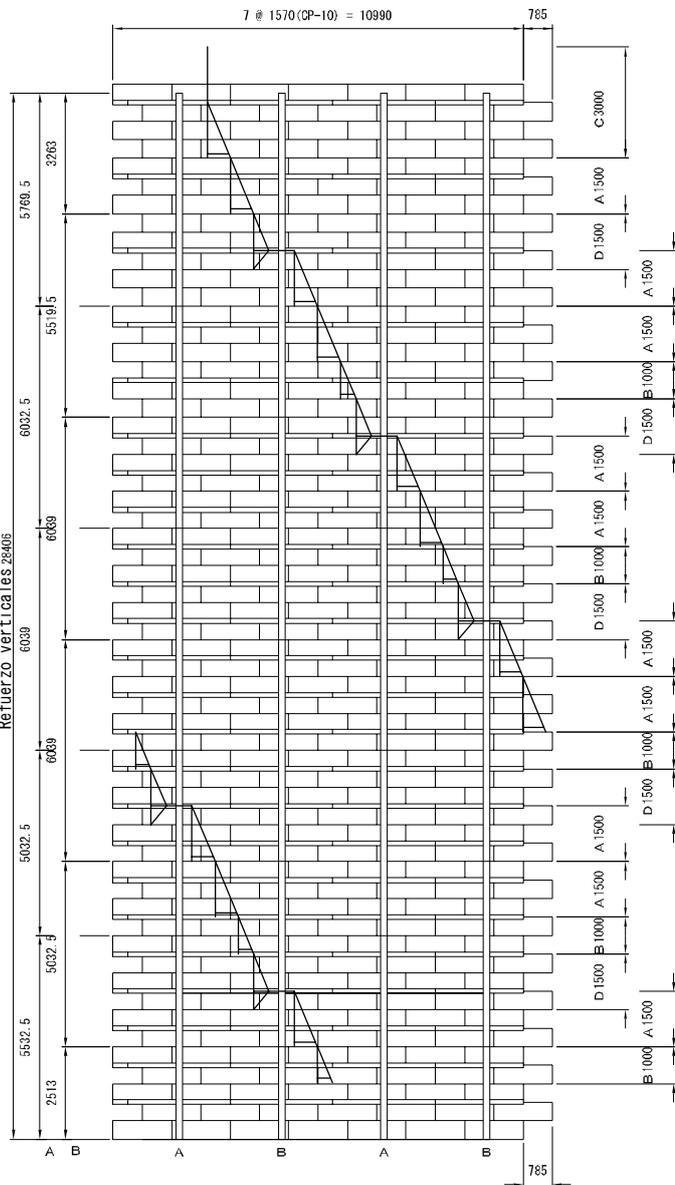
Plano estructural del pozo No.2 (El Berrinche)
